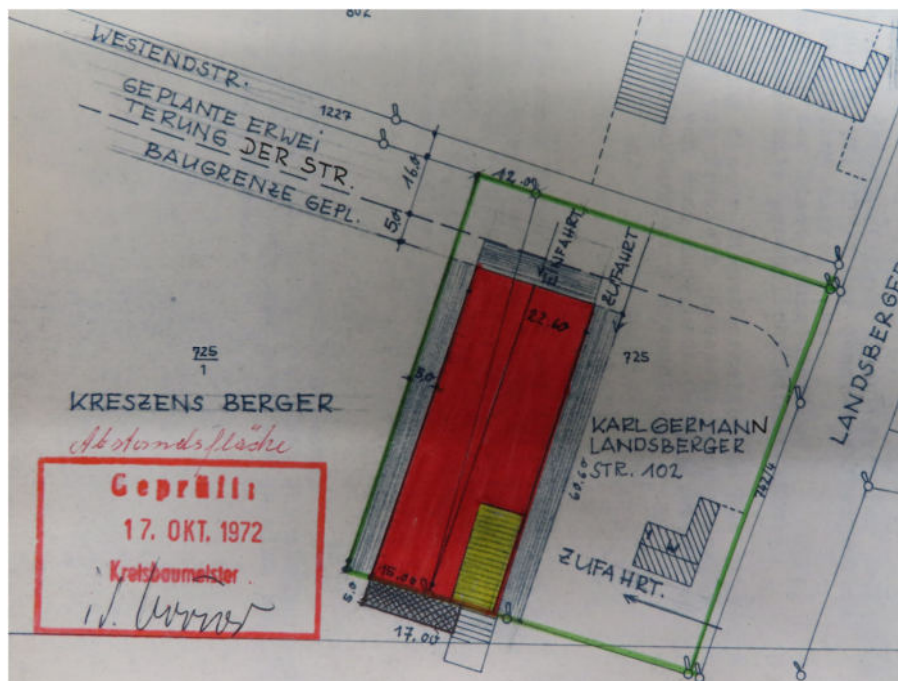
Lageplan aus der Abstandsflächenvereinbarung von 03.11.1972, Grenzabstandsflächen schwarzen schraffiert, die südliche, im Bild unten liegende Abstandsfläche ist Gegenstand der Grunddienstbarkeit, Kopie aus dem Dienstbarkeitsvertrag
